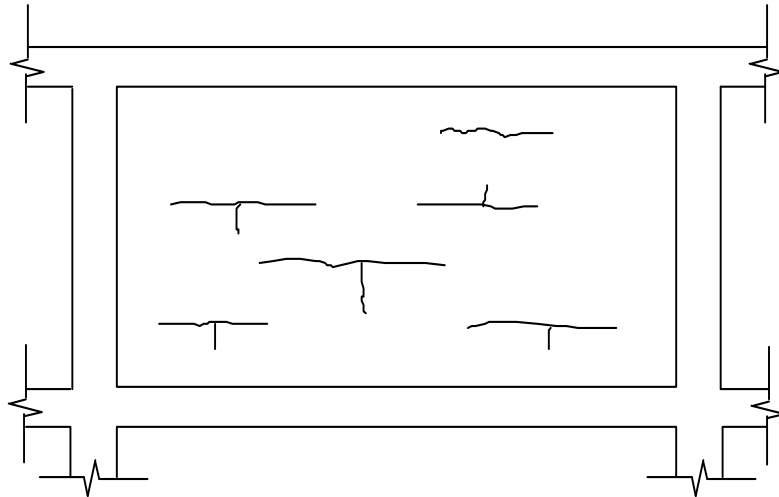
Trincas horizontais na alvenaria provenientes da expansão dos tijolos (adaptado de THOMAZ, 1989).
